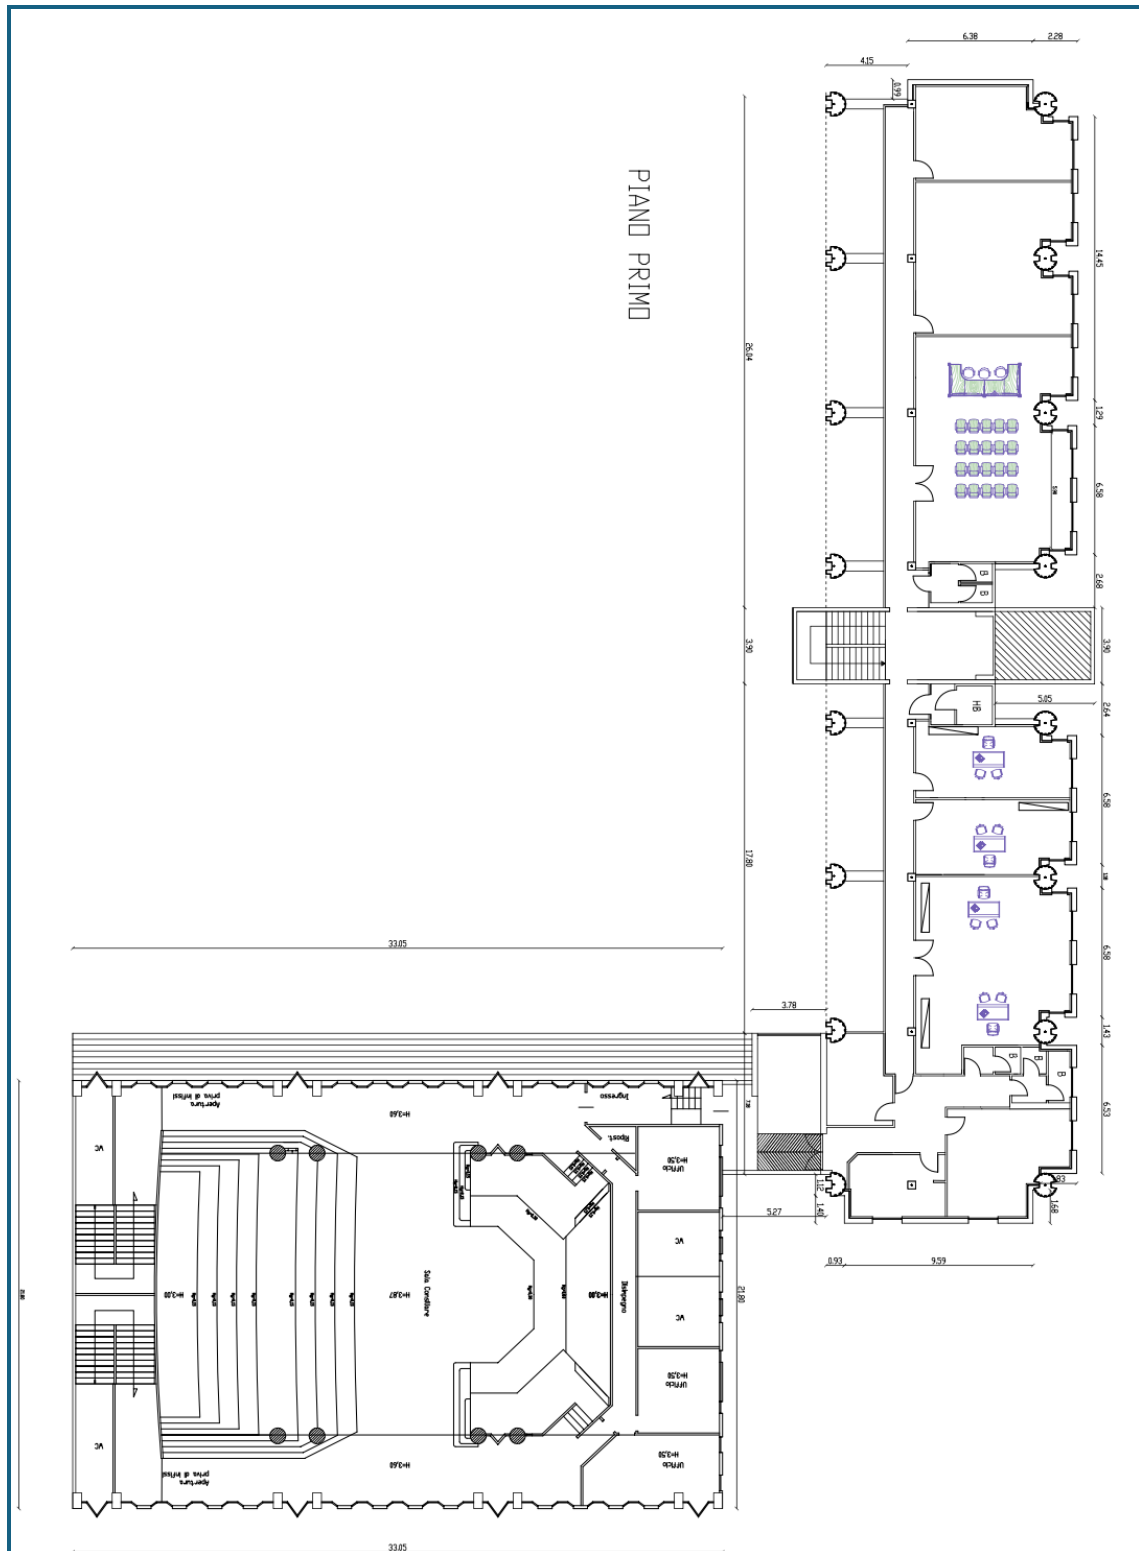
Planimetria Piano Primo DICOMAC - RENDE
